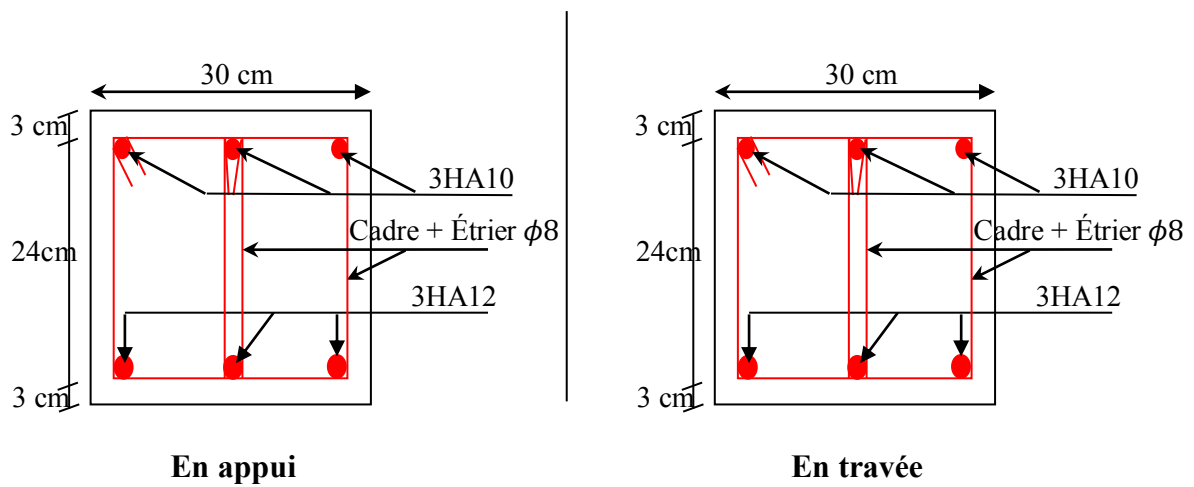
Schéma de ferrailage de la poutre de chaînage
